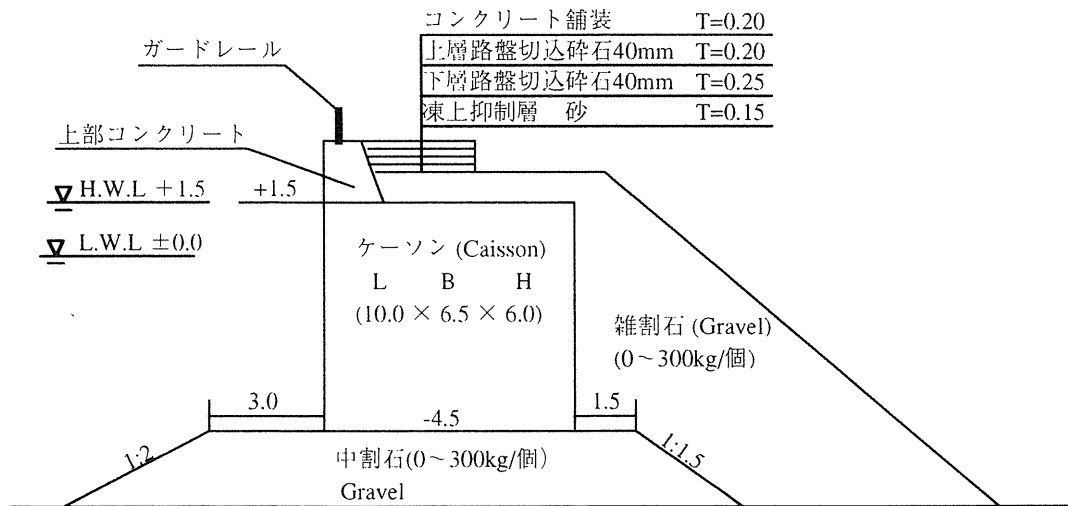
花咲港地区B用地護岸の重力式ケーソン標準断面図
